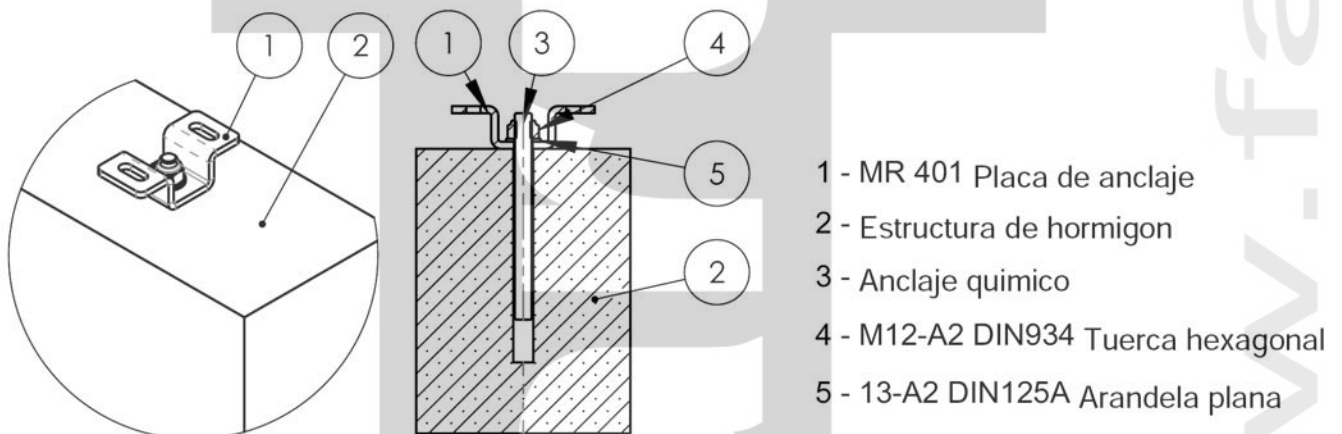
Placa de anclaje MR401 fijada a la estructura de hormigón con la ayuda de un anclaje individual
